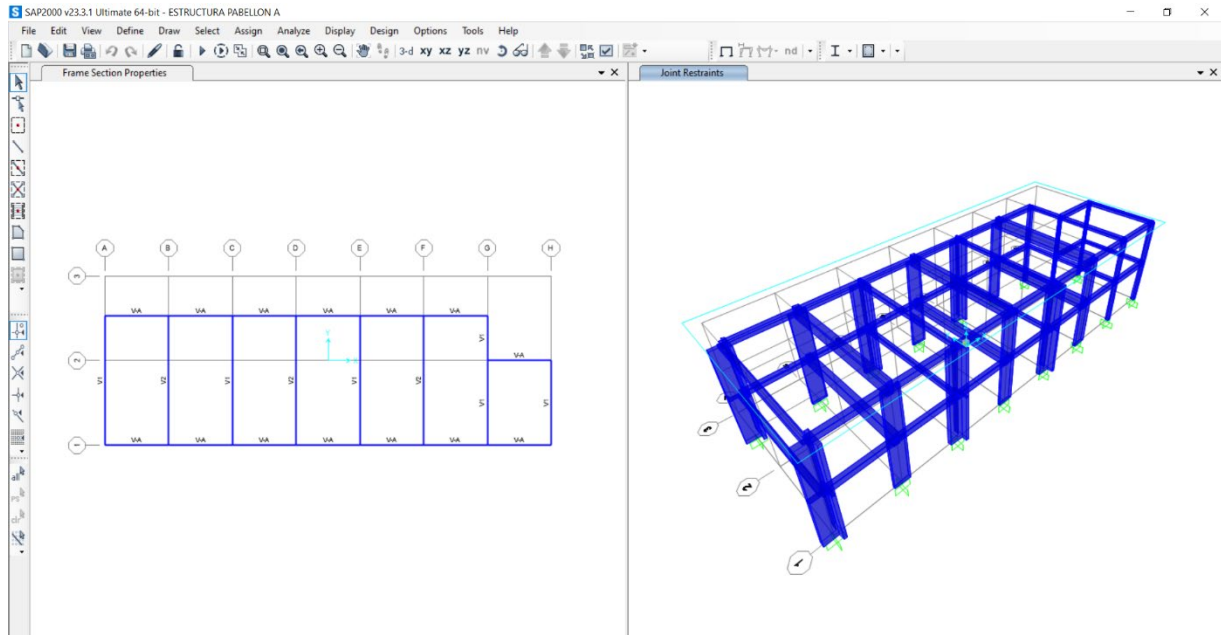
Inicio del modelamiento - Plano del pabellón A
